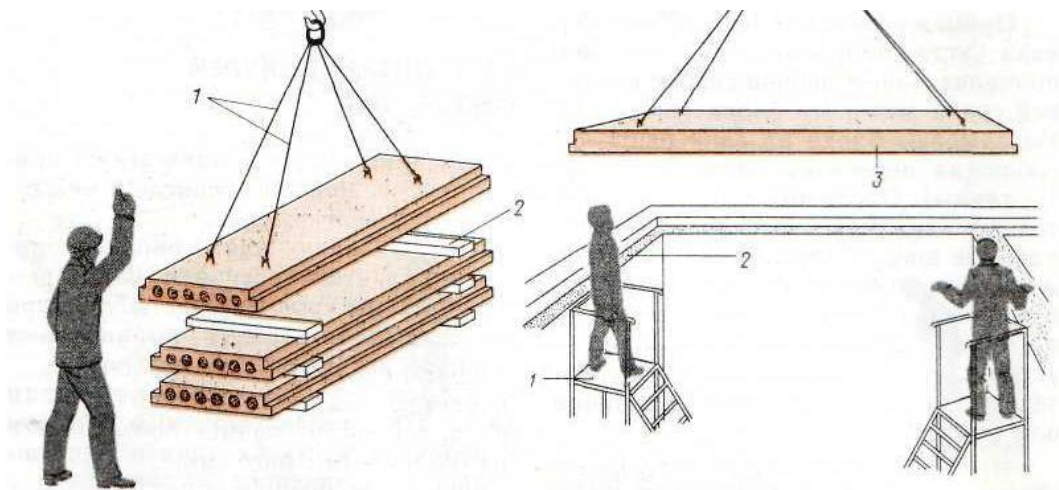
Схема стропування і подачі плит перекриття на місце монтажу.
